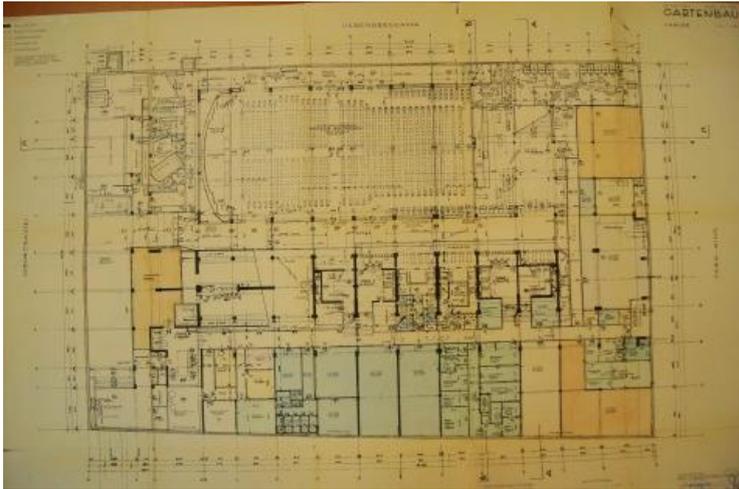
Gartenbaugebäude, Grundriss
